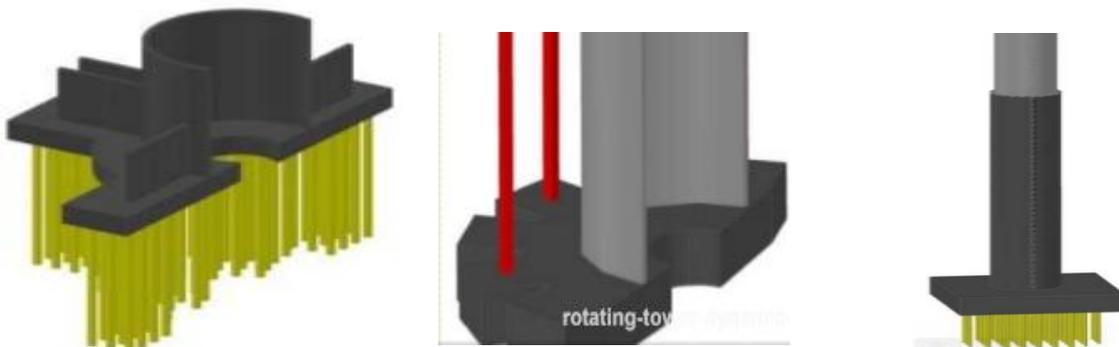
LES FONDATIONS, SOURCE : WIKIPEDIA MODIFIER PAR HAUTEUR
